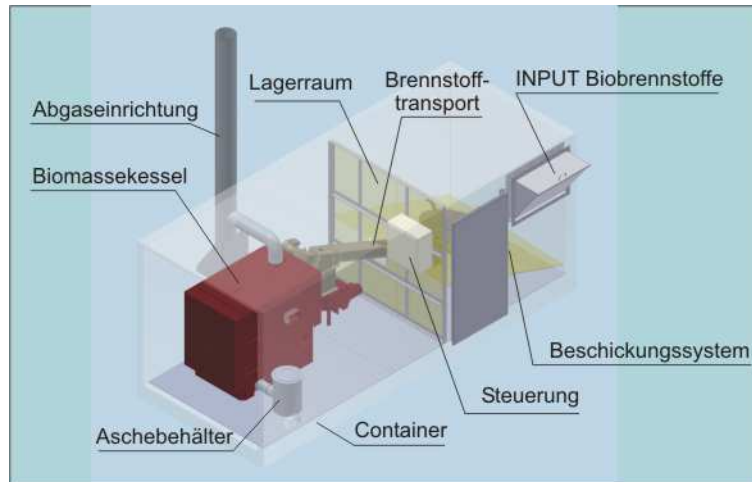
3D-Layout Container mit Kessel- und Lagerraum
